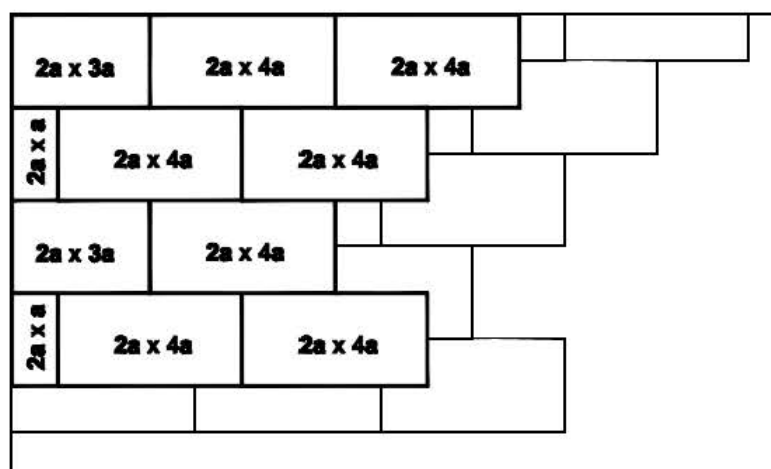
Раскладка теплоизоляционных плит при двухслойной укладке
